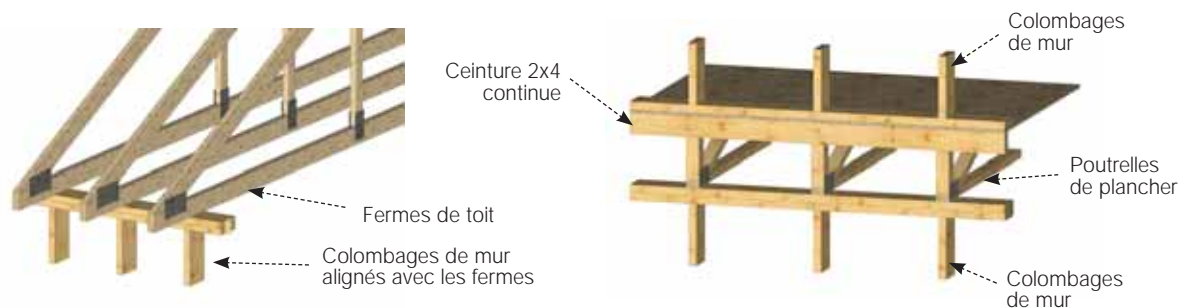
• Alignement des colombages de murs avec les fermes de toit et les poutrelles de plancher
